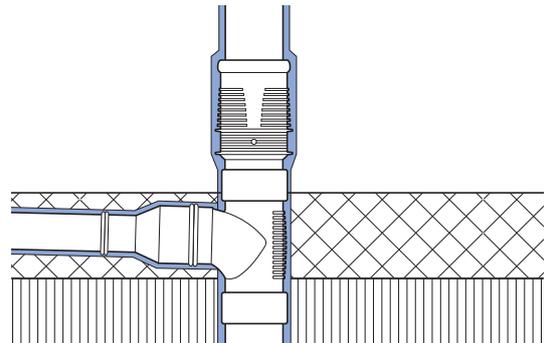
Fixpunkt über egalem Abzweig in Betonschicht der Holz-Beton-Verbunddecke
